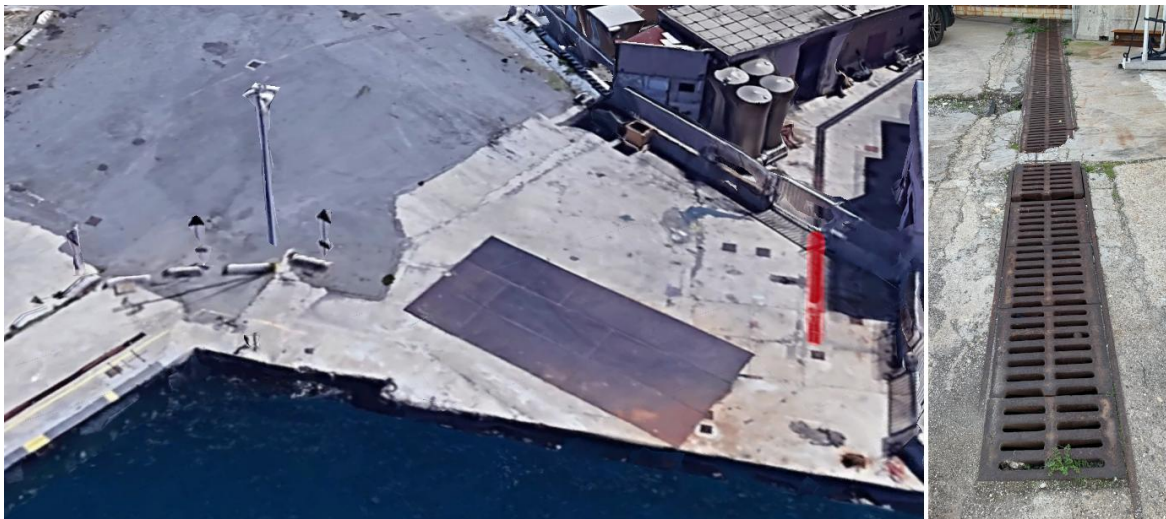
Area di intervento con in evidenza la canaletta di drenaggio e foto di dettaglio
